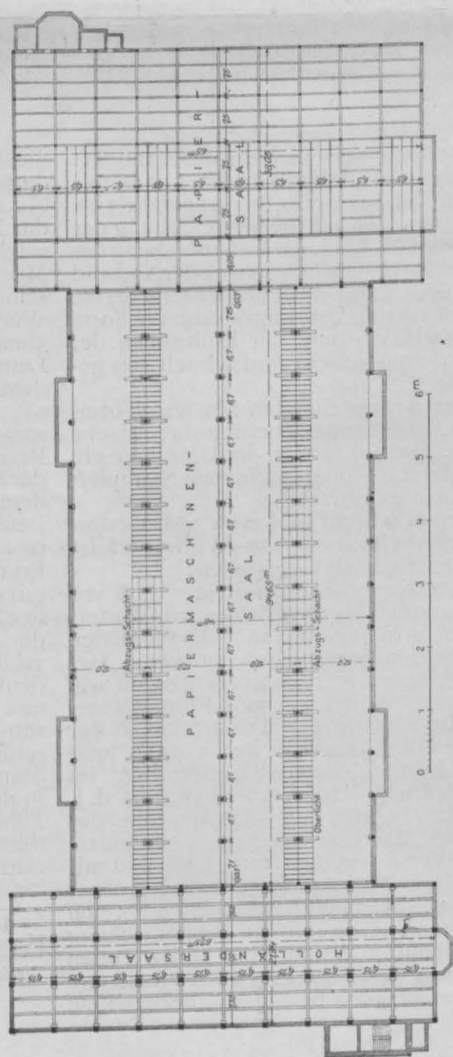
Grundriß des Hauptgebäudes in Erdgeschoßhöhe.
